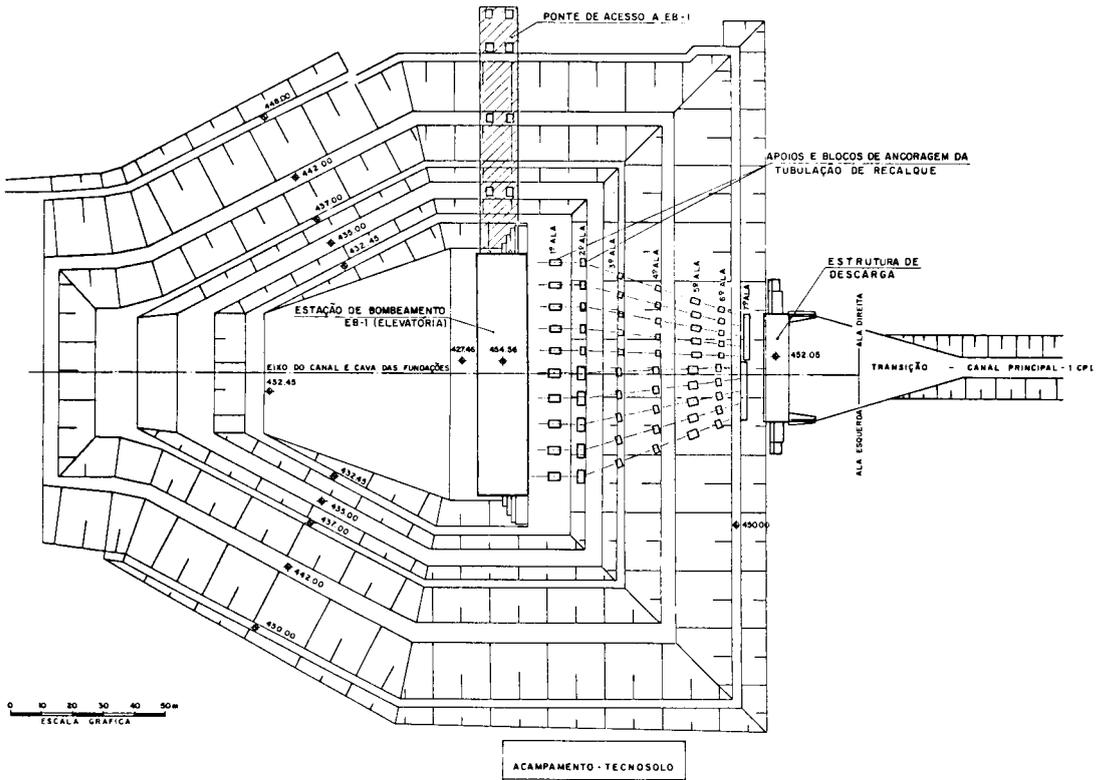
Conjunto de estruturas em torno da Estação de Bombeamento-EB-1 — Jaíba (Planta)
